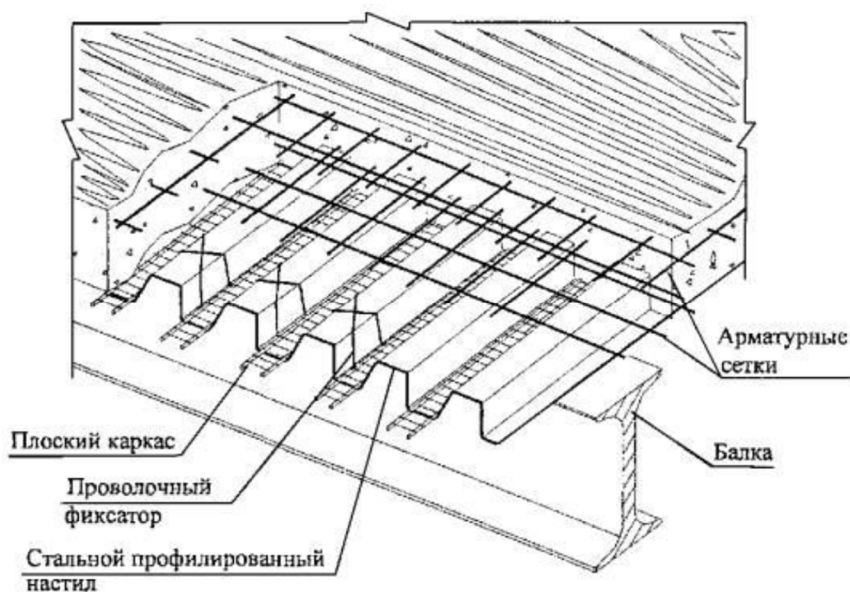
Конструкция монолитного перекрытия с применением стального профилированного настила в качестве несъемной опалубки
